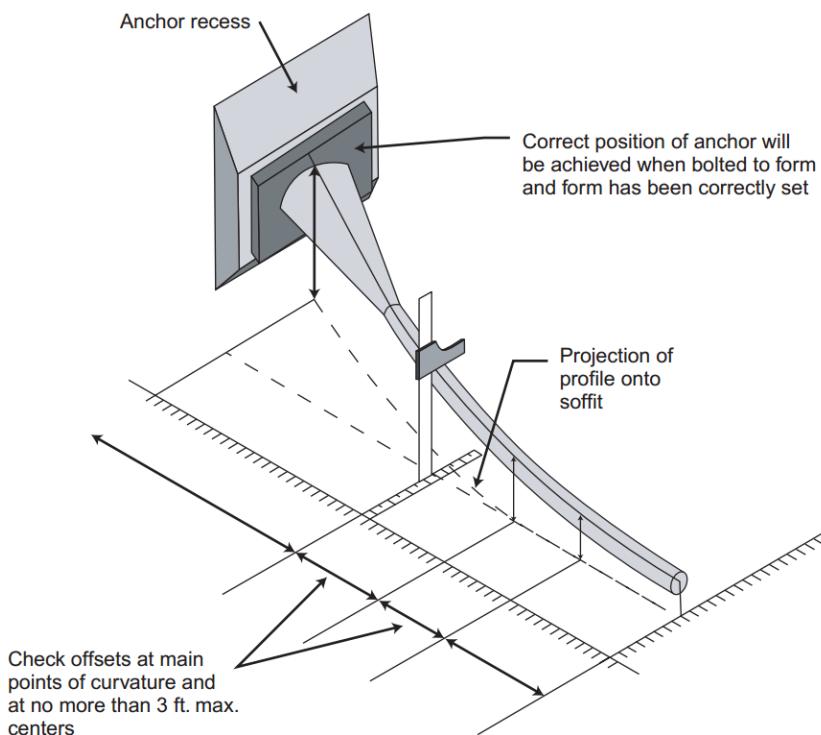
Rebajo de anclaje y comprobación de la alineación del ducto.
